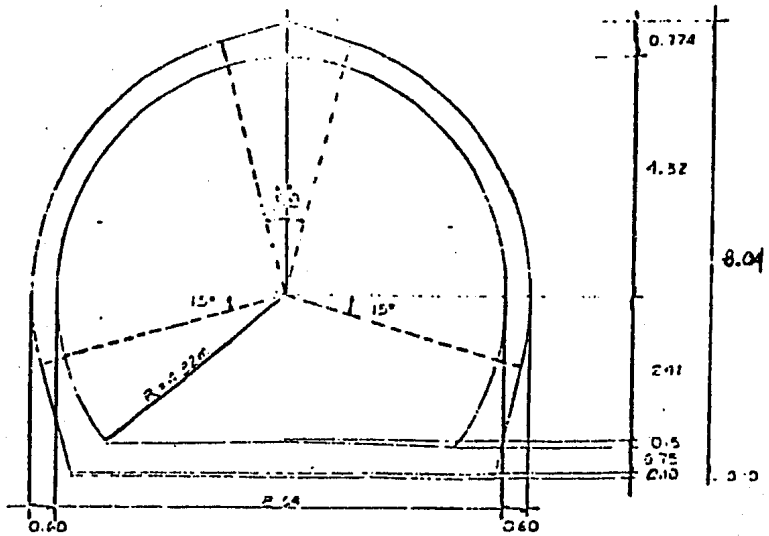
a SECCION TRANSVERSAL TIPO 1
